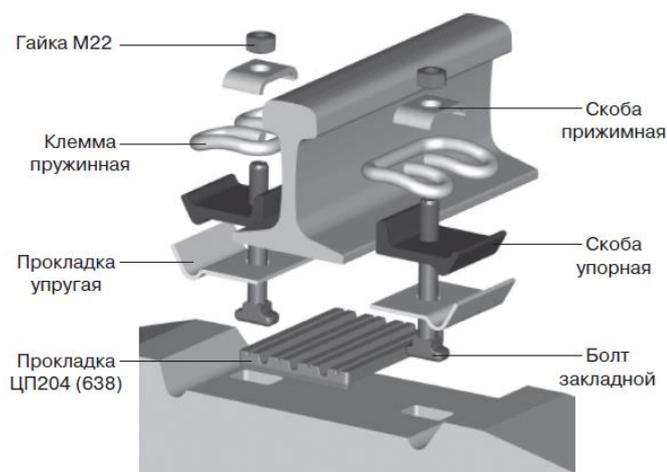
Общий вид конструкции скрепления ЖБР-65
